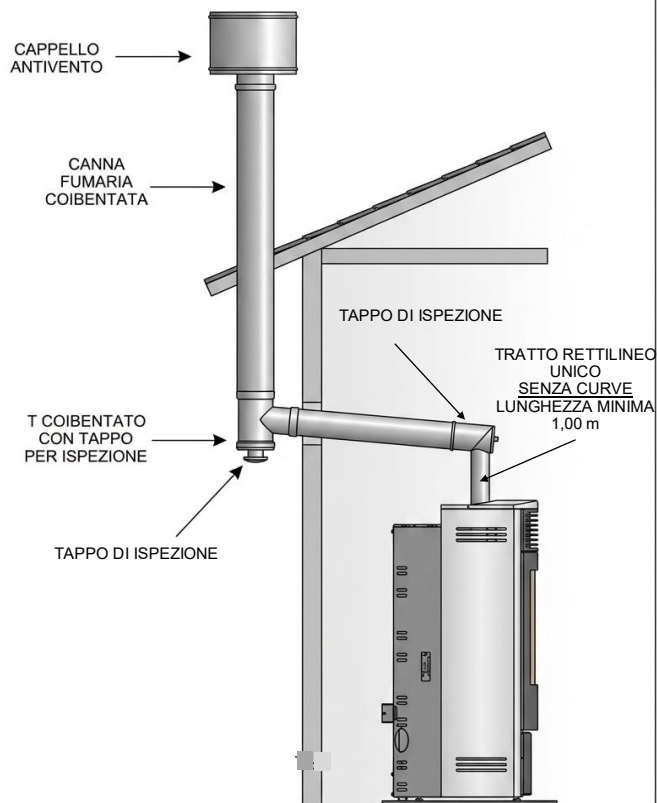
D – Installazione canna fumaria interna - esterna.
